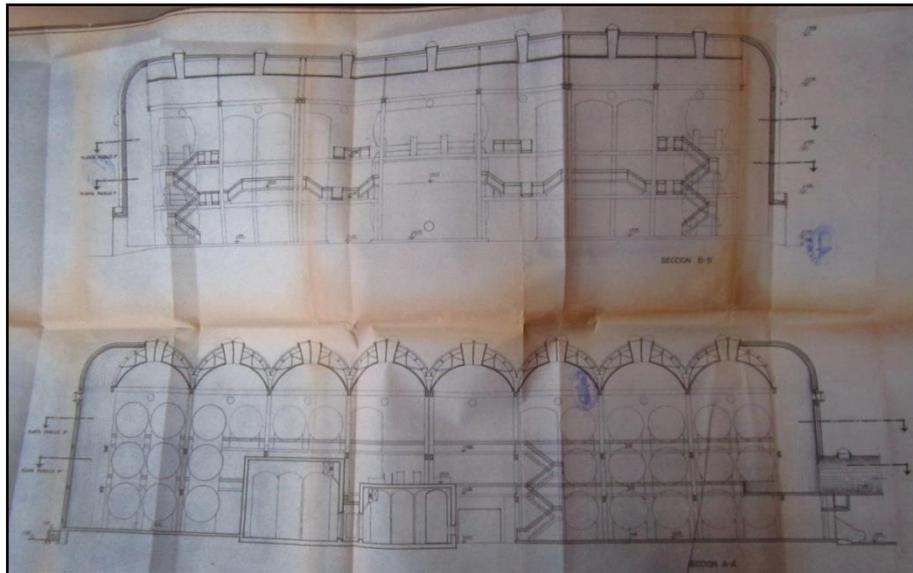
Plano nº20 de secciones del proyecto. (Fuente: AMA)
